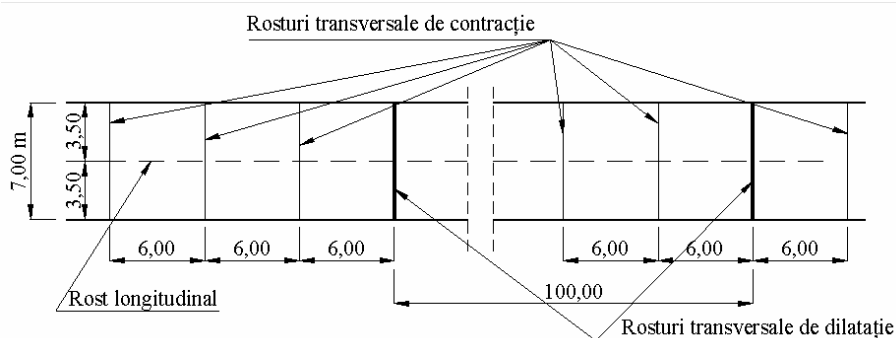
Schema în plan a unei îmbrăcăminți rutiere din beton de ciment.
